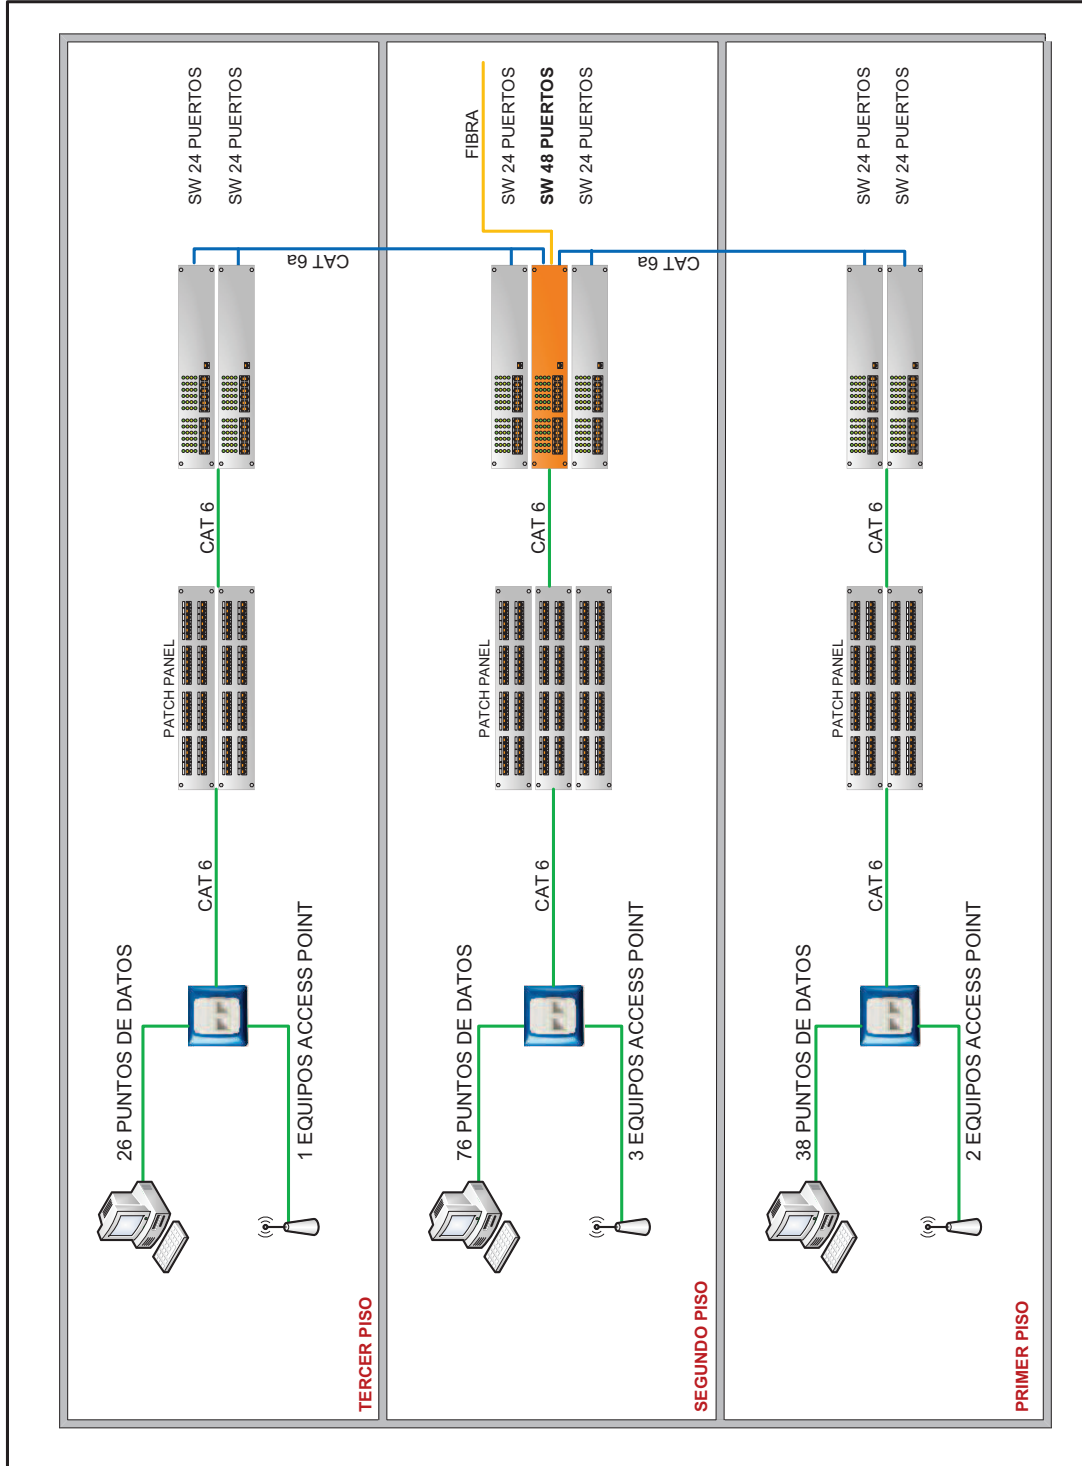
Cableado horizontal y vertical en el edificio Central - lado norte
